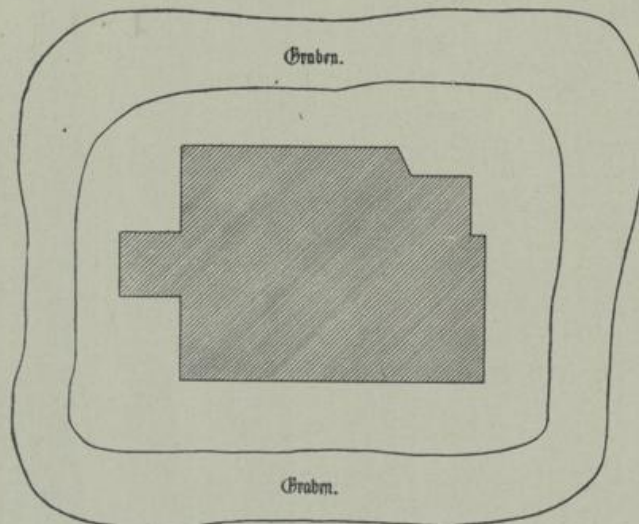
Wolfshagen. Lageplan der alten Burg.
